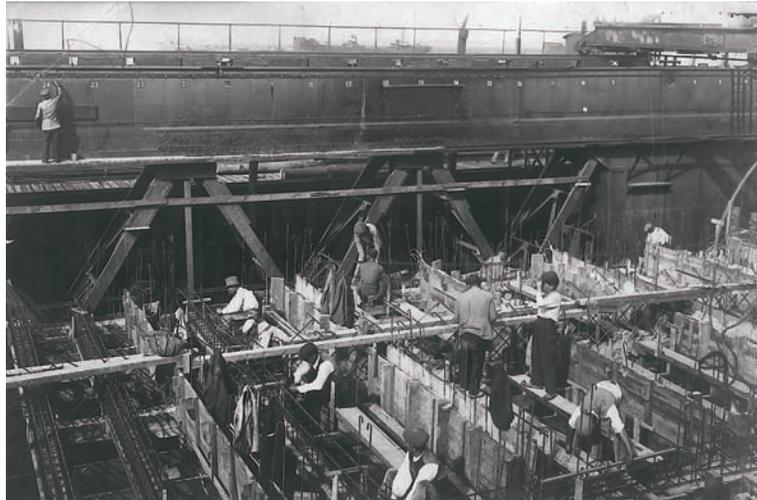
Fotografía del dique flotante utilizado para ejecutar los cajones del muelle de Levante, durante la construcción de las obras.
